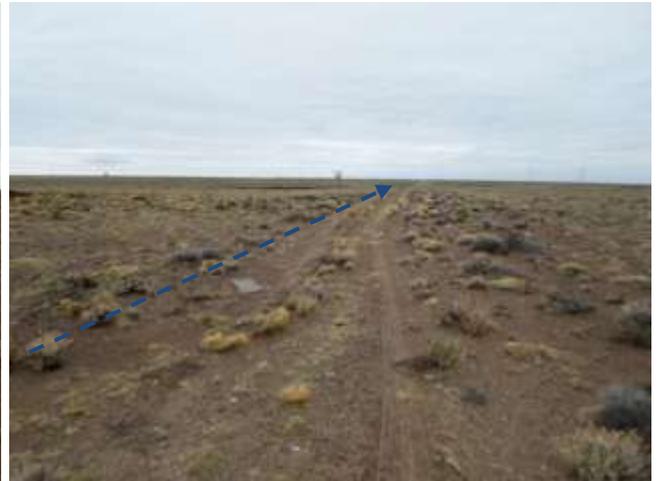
Emplazamiento por picada existente parcialmente revegetada. Foto en dirección N.
